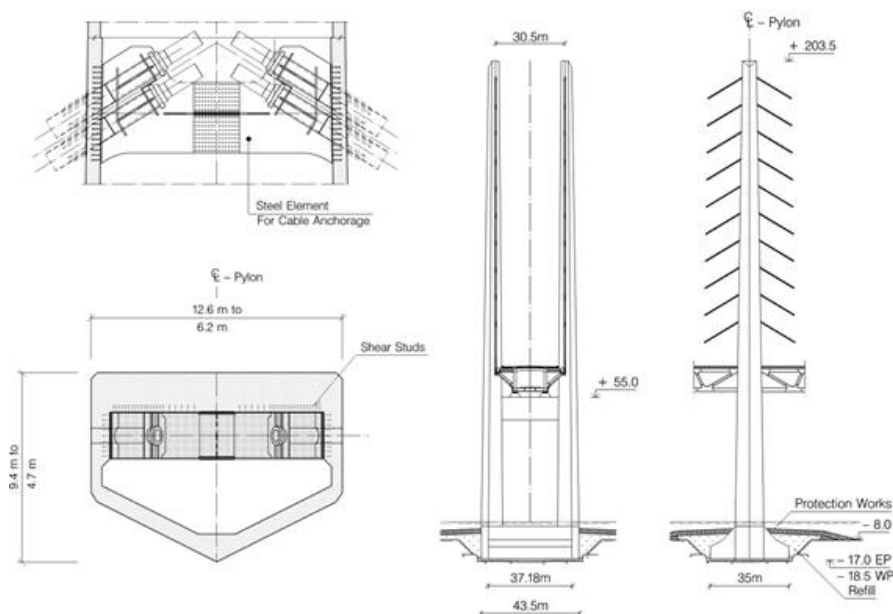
Ancoragens, alçado longitudinal, secção transversal das torres [82]
